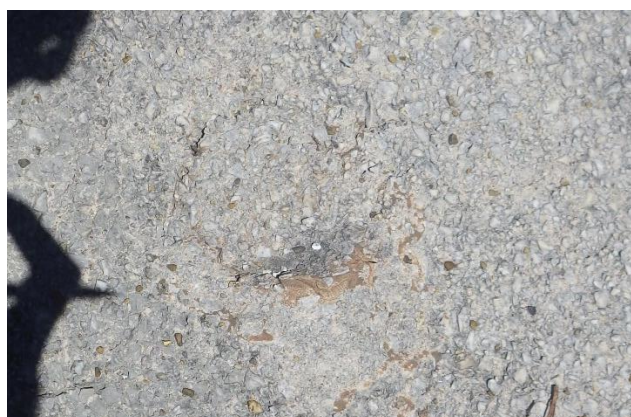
Défaut n°49 – Forage rebouché sur la bande n°1 (sans évolution par rapport à 2013)
